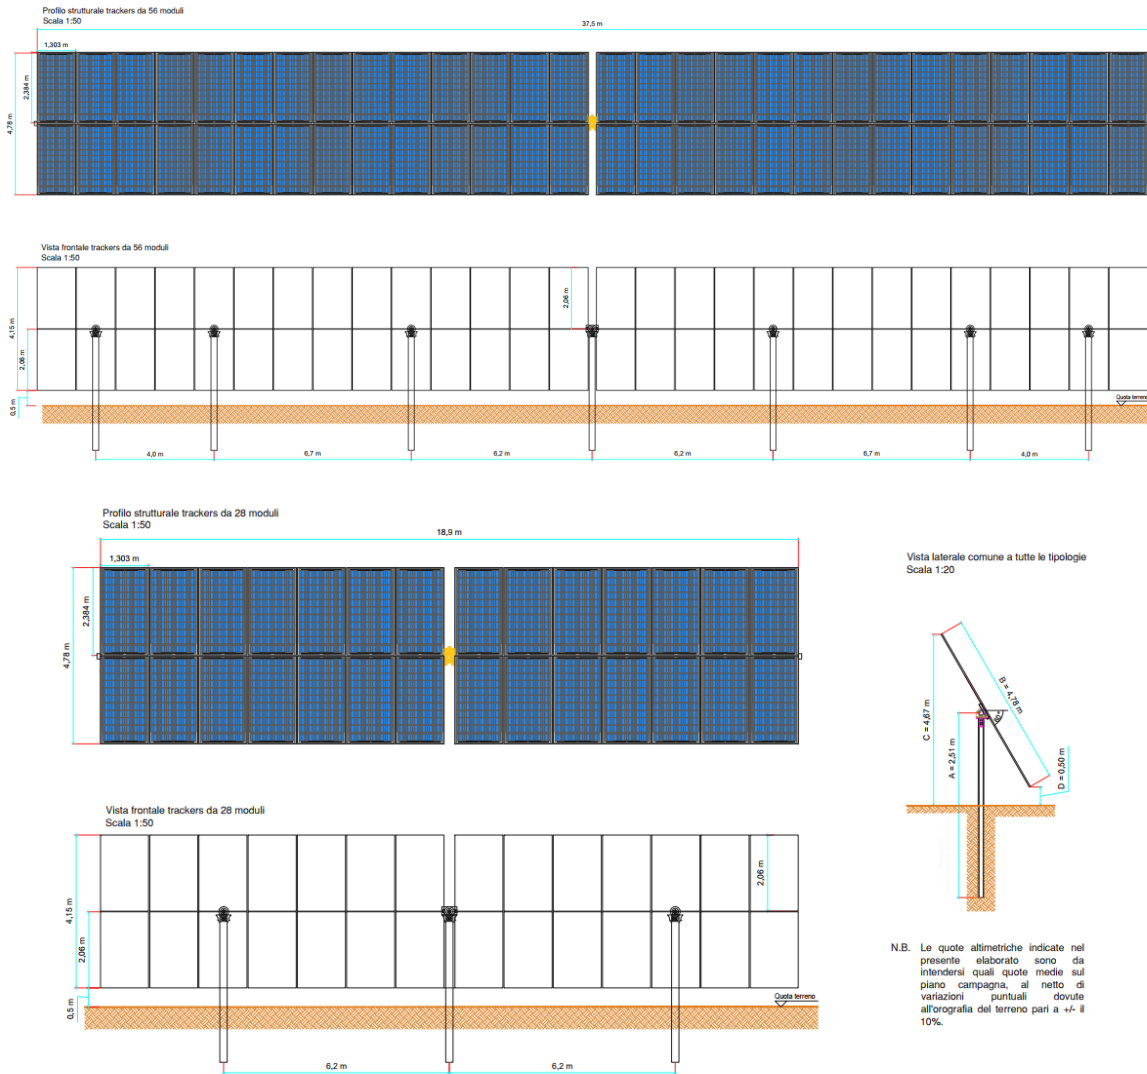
Pianta e prospetto e sezione trasversale tracker monoassiali di progetto (da 28 moduli e da 56 moduli)
